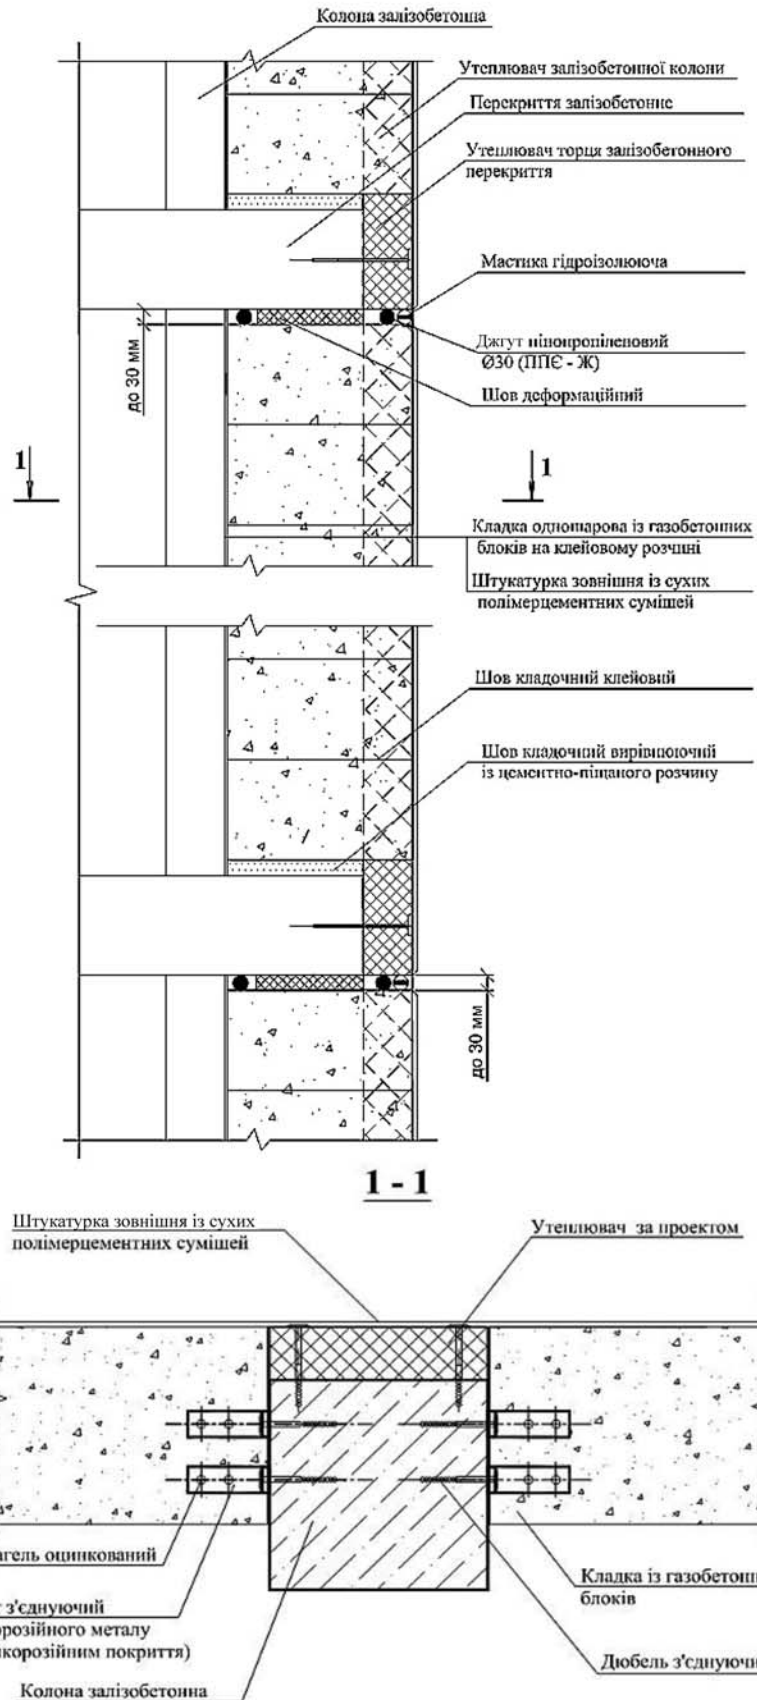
Стіна зовнішня із газобетонних блоків із обштукатуренням та утепленням перекриття пінополістиролом
